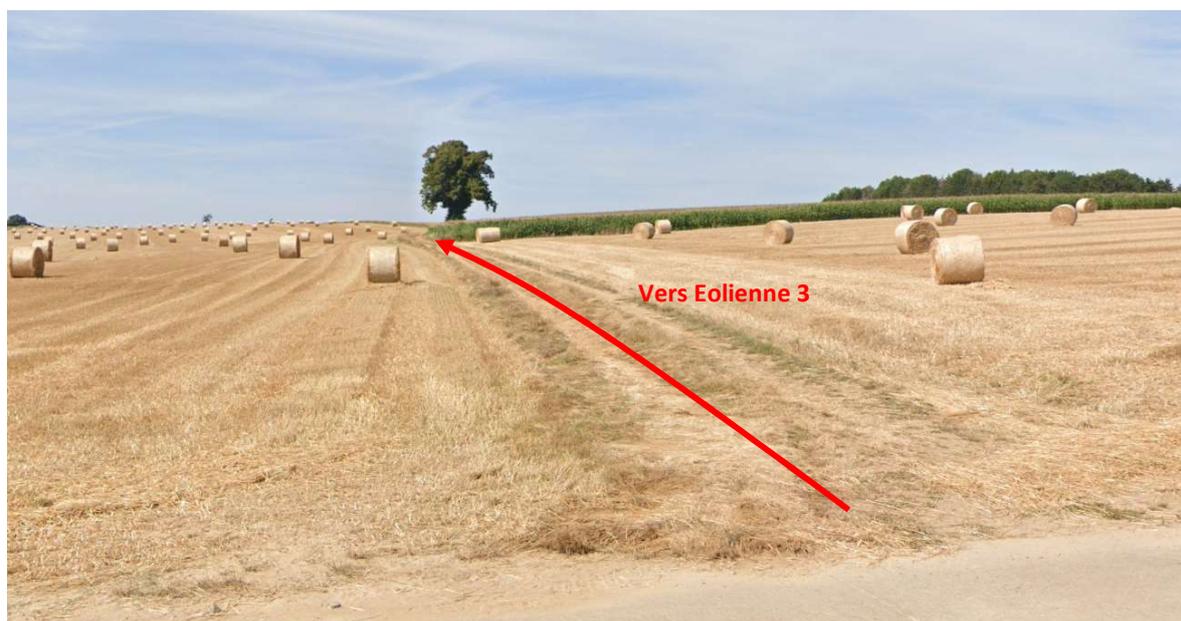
Accès au chantier – chemin n°27 existant à stabiliser avec un empierrement
